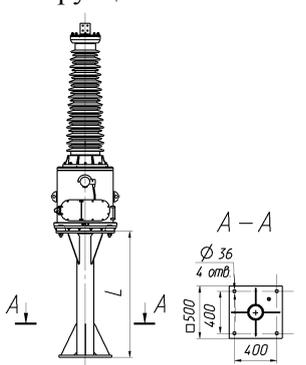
Установка блока трансформаторов напряжения ЗНГ-УЭТМ®-110 на заводской металлоконструкции
